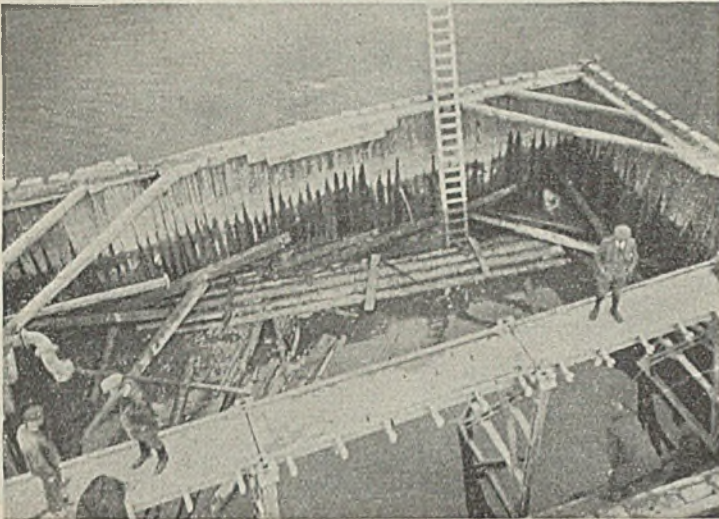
Steg nebst Nadelwehrböcken der linken Wehrhälfte fertig montiert. Aussteifung des Spundwandkastens fast ganz ausgebaut (s. Abb. 14).
